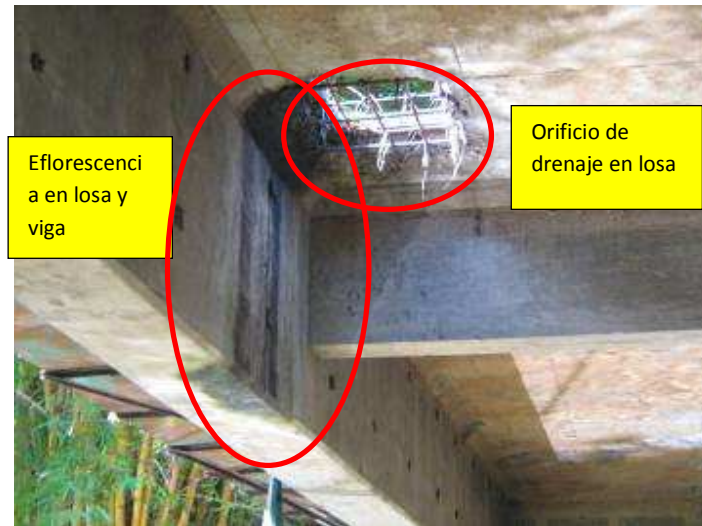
Ducto de drenaje en losa donde se observa eflorescencia por agua drenada en losa y viga.
